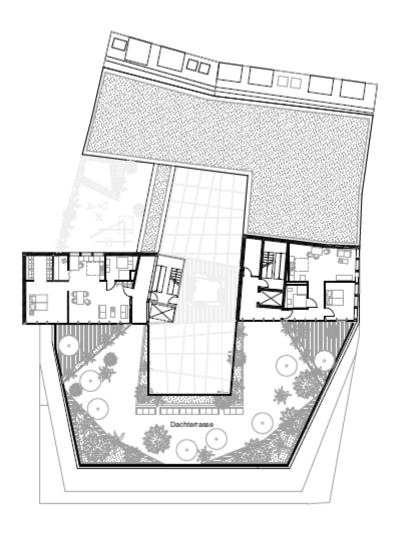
Grundriss 4. Obergeschoss (Mars-Architekten, 2020)
